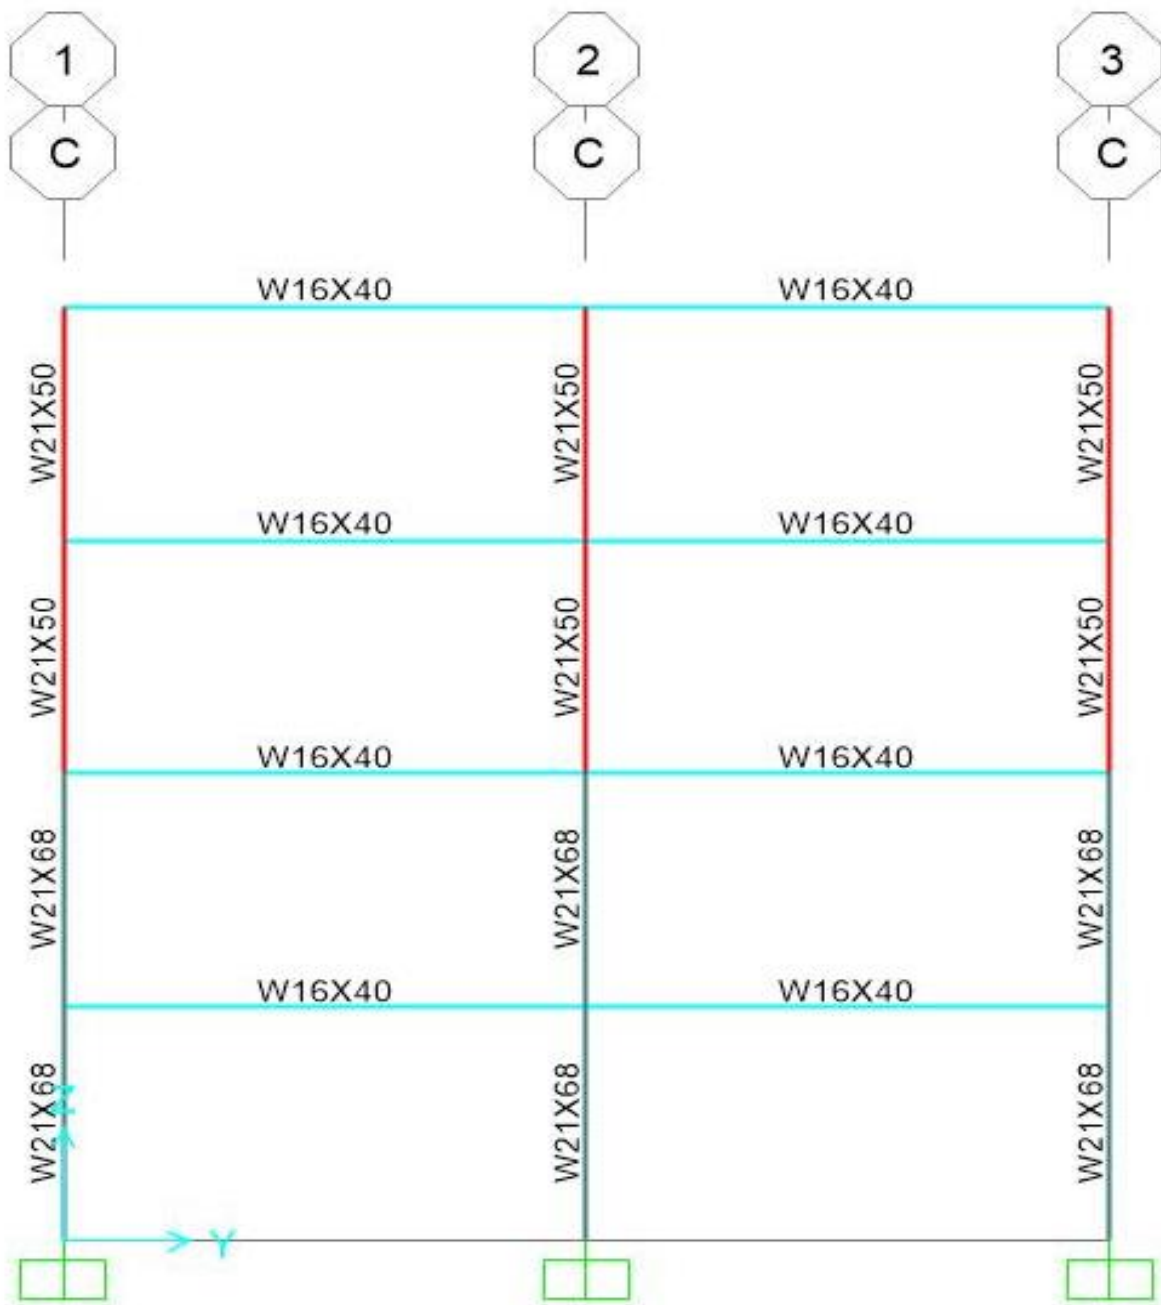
9 elevación estructural EJE-C (Fuente propia).
